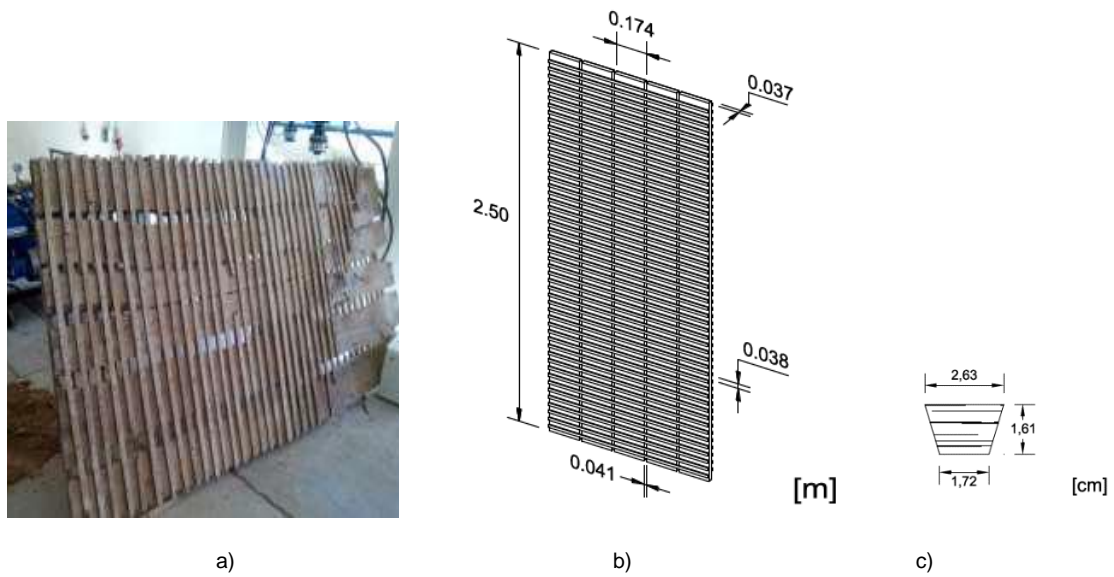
a) 2ª Parede de tabique recolhida para o ensaio – Parede de tabique simples; b) Detalhe construtivo da parede de tabique; c) Detalhe construtivo das ripas com secção transversal trapezoidal [13]
